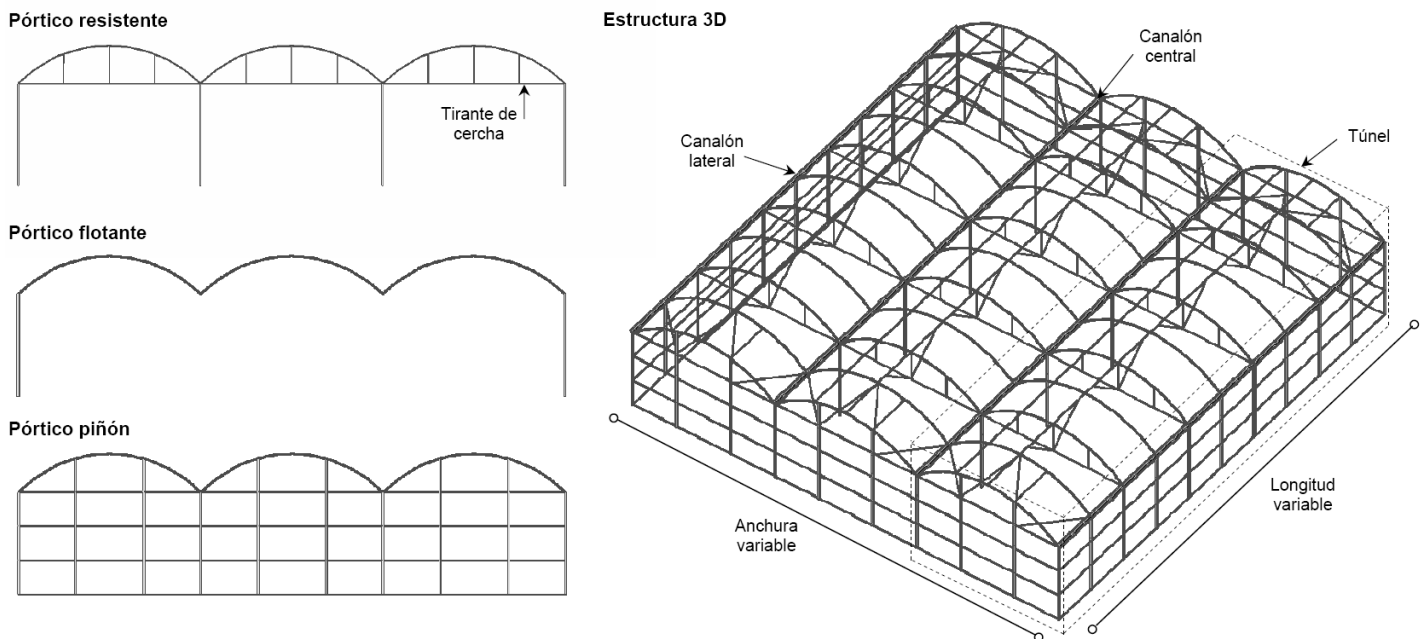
Alzados de los tres pórticos tipo y vista tridimensional de las estructuras estudiadas.
